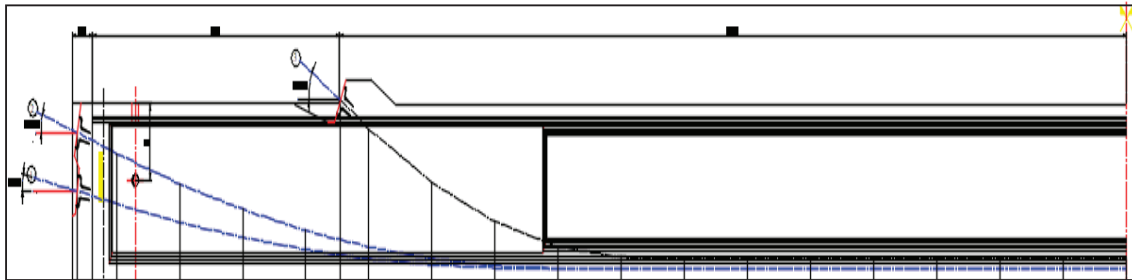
Schéma du tracé des câbles sur demi-poutre
